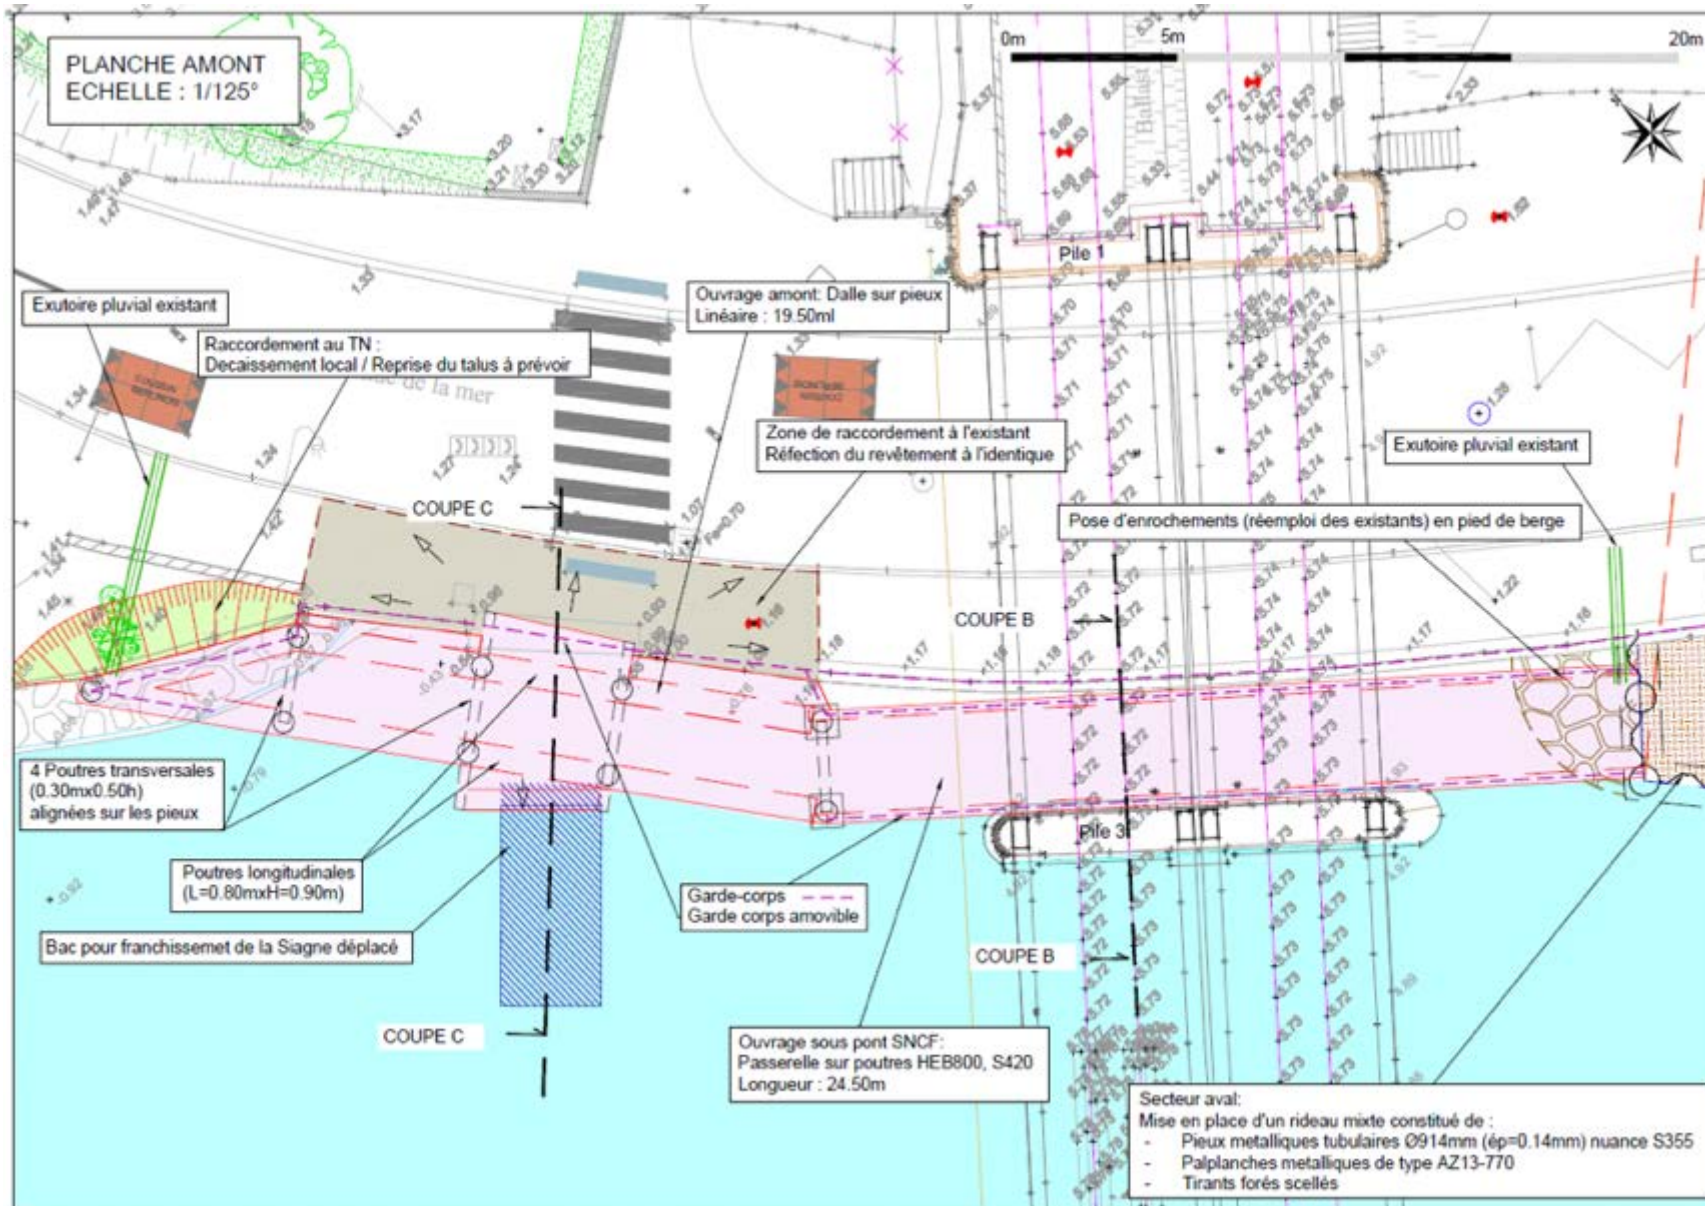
Plan général des travaux projetés - partie Pont SNCF et amont
